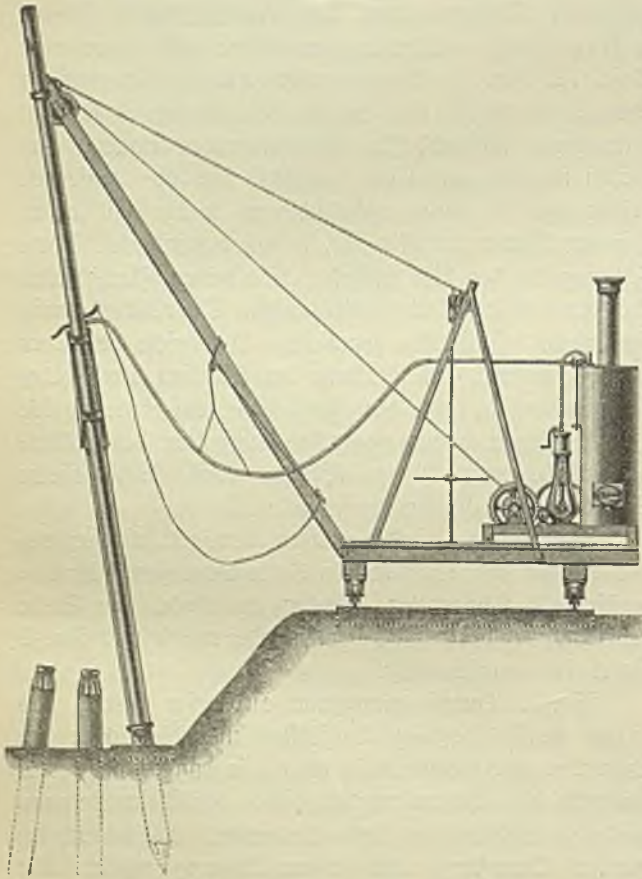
, Dampframmen mit endloser Kette; das eiserne Gerüst steht auf Laufrollen und die Achsen der Laufräder sind horizontal drehbar, so daß es nach jeder Richtung hin befahren werden kann. Bei diesen Rammen wird der Rücklauf der Kette vermieden, und dadurch bei gleicher Dampfkraft eine größere Leistung erzielt. Die Maschinenleistung derselben ist gleich gut bei kleinen und großen Fallhöhen, man kann also bei weichem wie bei hartem Boden mit gleichbleibender Leistung leichte und
